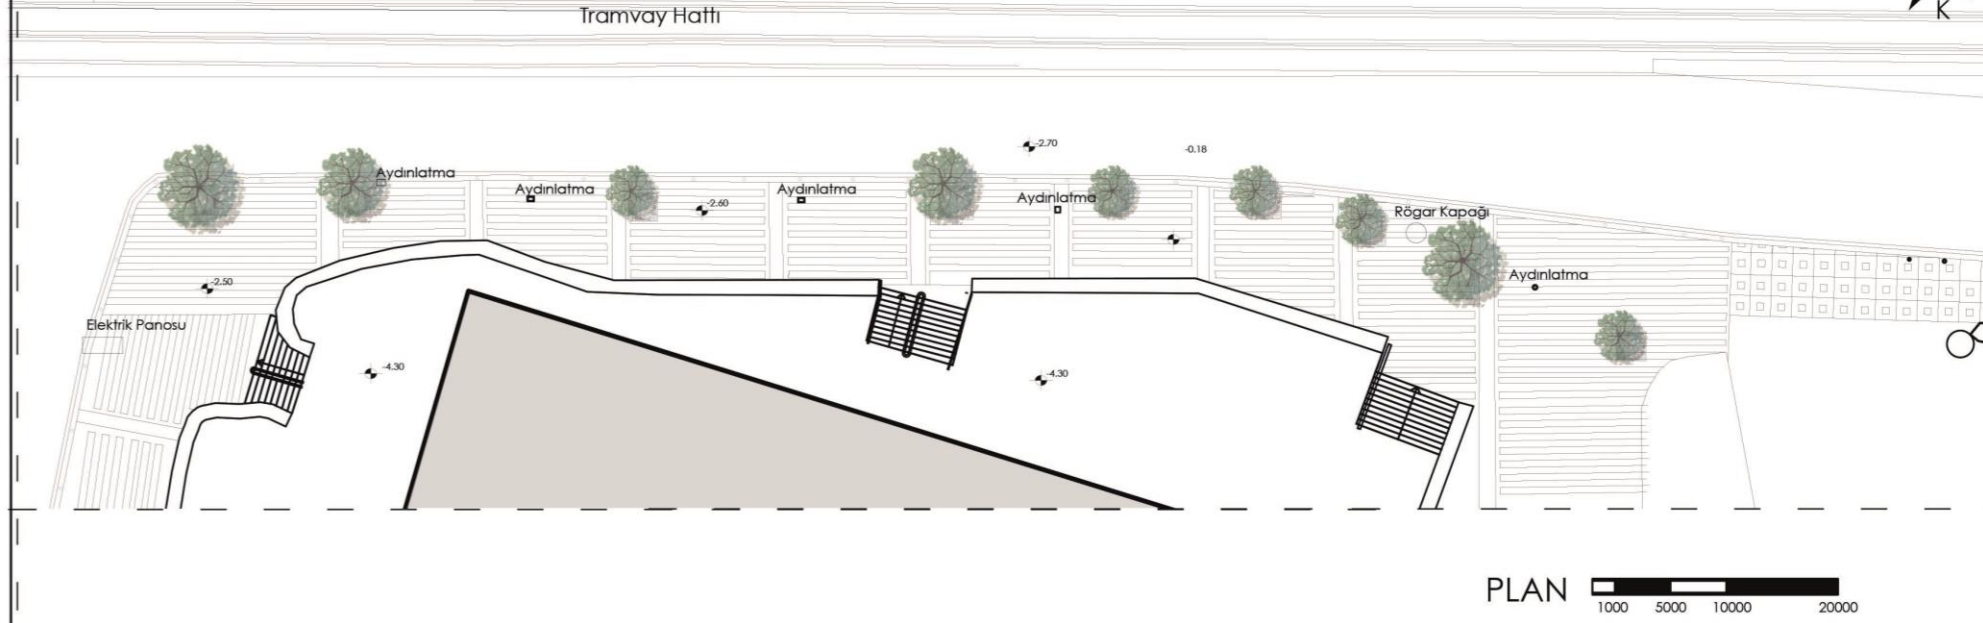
Mekân bölümü 1 plan, kesit, görünüşler ve deneyim yürüyüşü raporu
